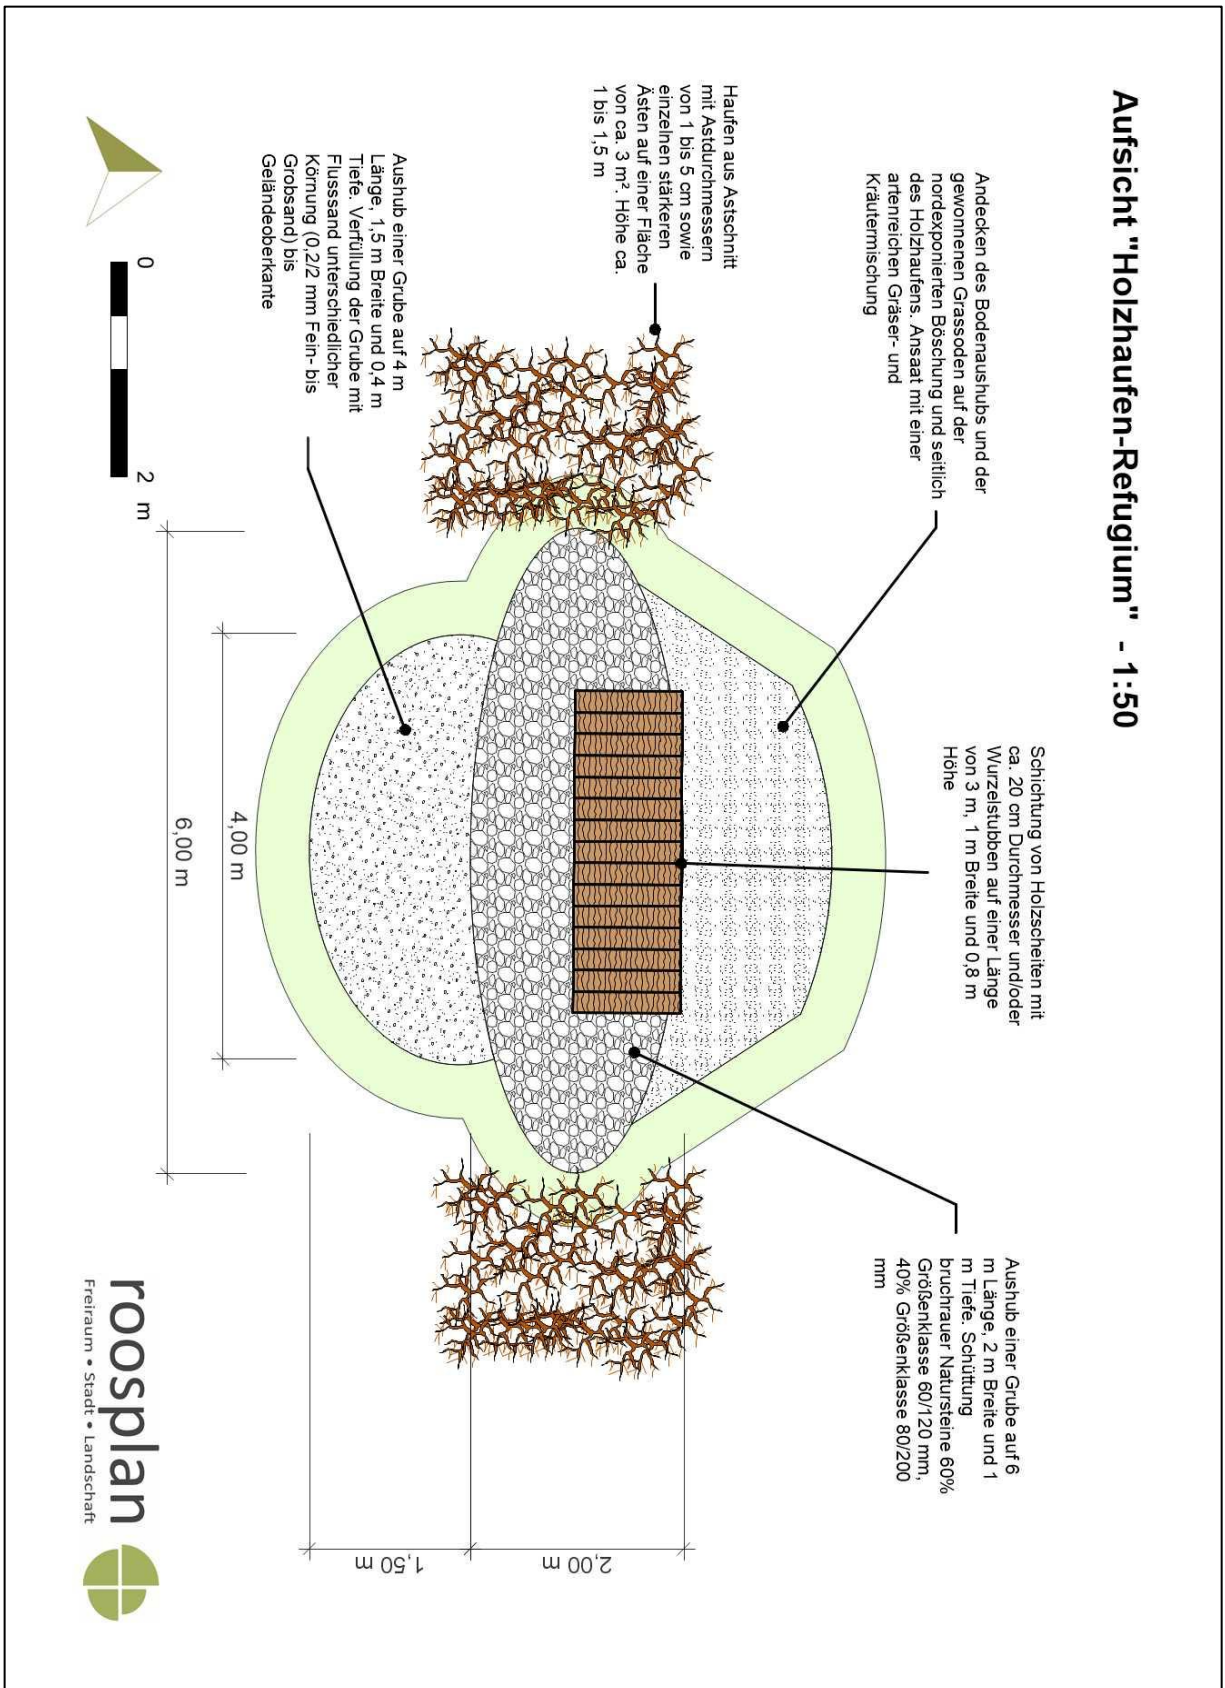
Detailskizze Holzhaufen-Refugium Aufsicht
